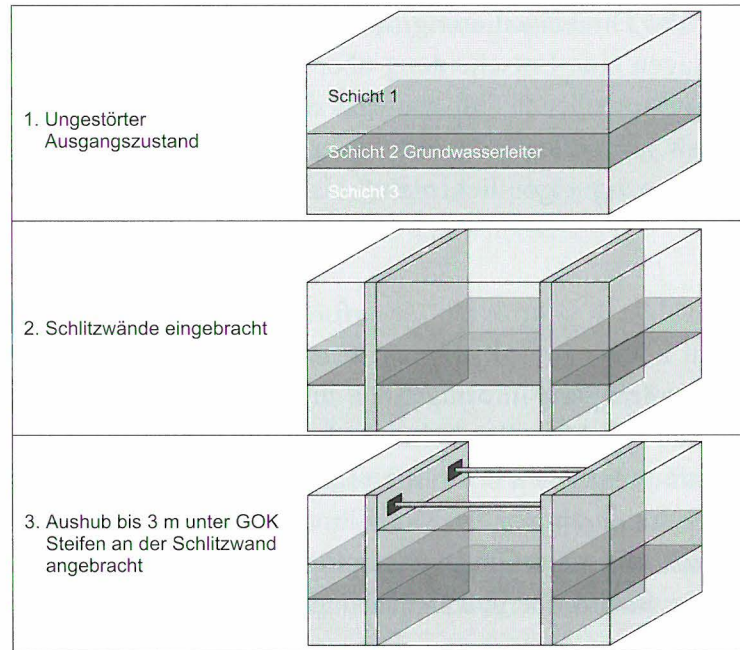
Bauzustände zur Erstellung einer Baugrube im Grundwasser
